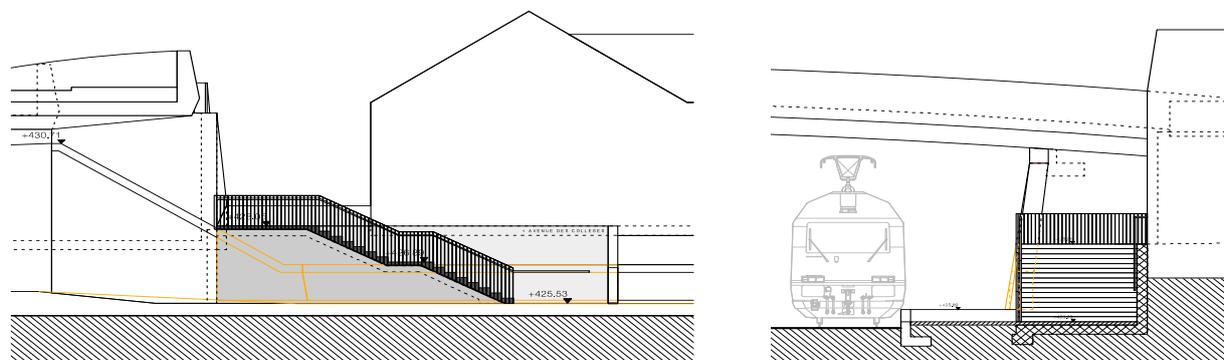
Accès Sud-Ouest _ élévation et coupe transversale _ échelle : 1/200
